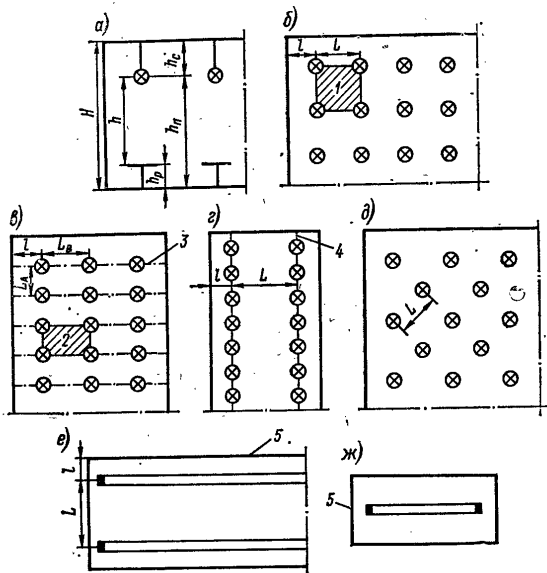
Схемы размещения светильников: а — в разрезе; б — ж — в плане
